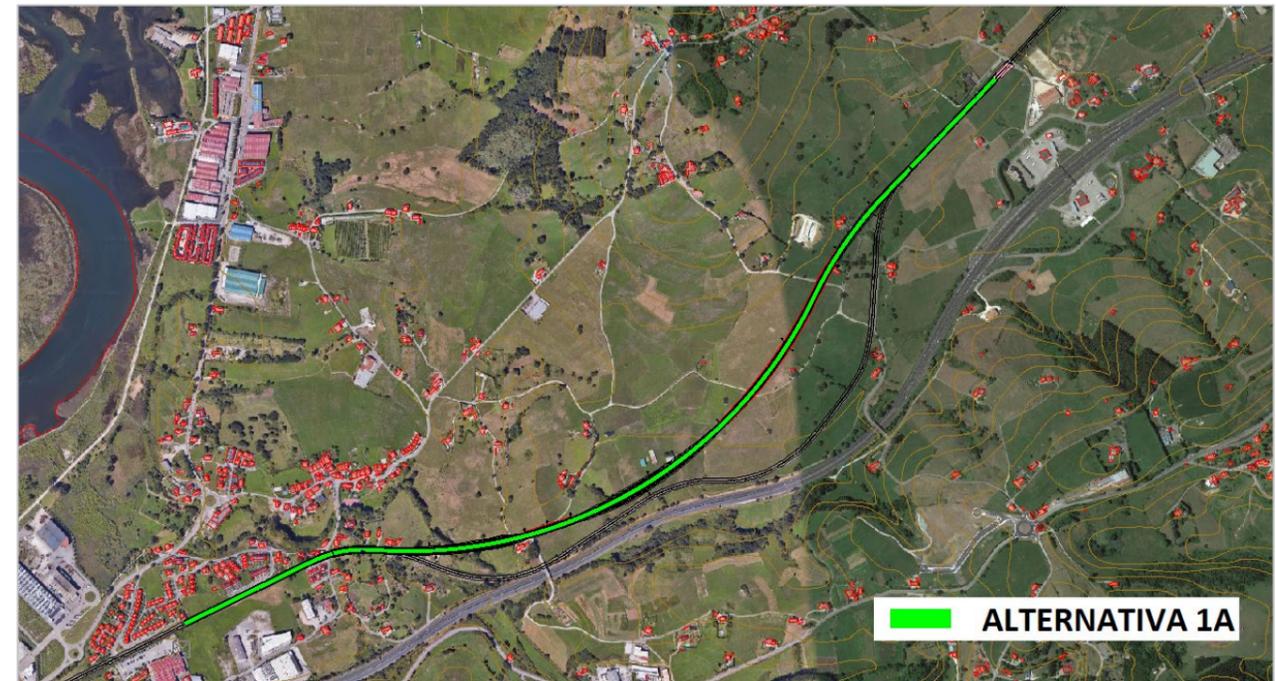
Trazado en planta de la alternativa 1A. Fuente: Istram
